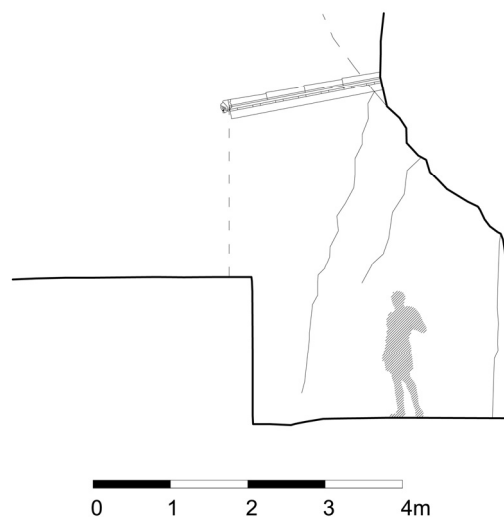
Sección longitudinal de la gruta. Posible cubierta con las antefijas de cabeza de sileno.
